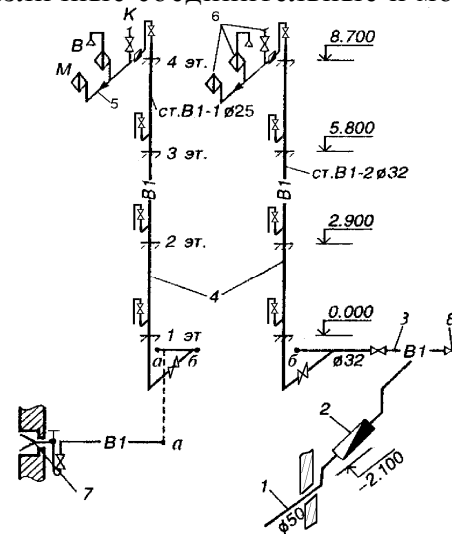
Элементы внутреннего водопровода (тупиковая схема внутреннего водопровода): 1 – ввод; 2 – водомерный узел; 3 – разводящая магистраль; 4 – стояки; 5 – подводы к водоразборной арматуре в квартирах; 6 – водоразборные устройства; 7 – поливочный кран; 8 – запорная арматура
